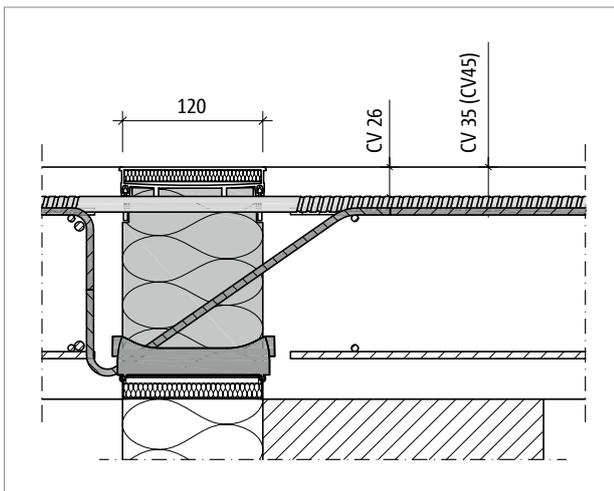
Schöck Isokorb® CXT Typ K-CV26: Betondeckung der Querkräftstäbe CV35 (CV45 bei ungeraden Isokorbhöhen)
